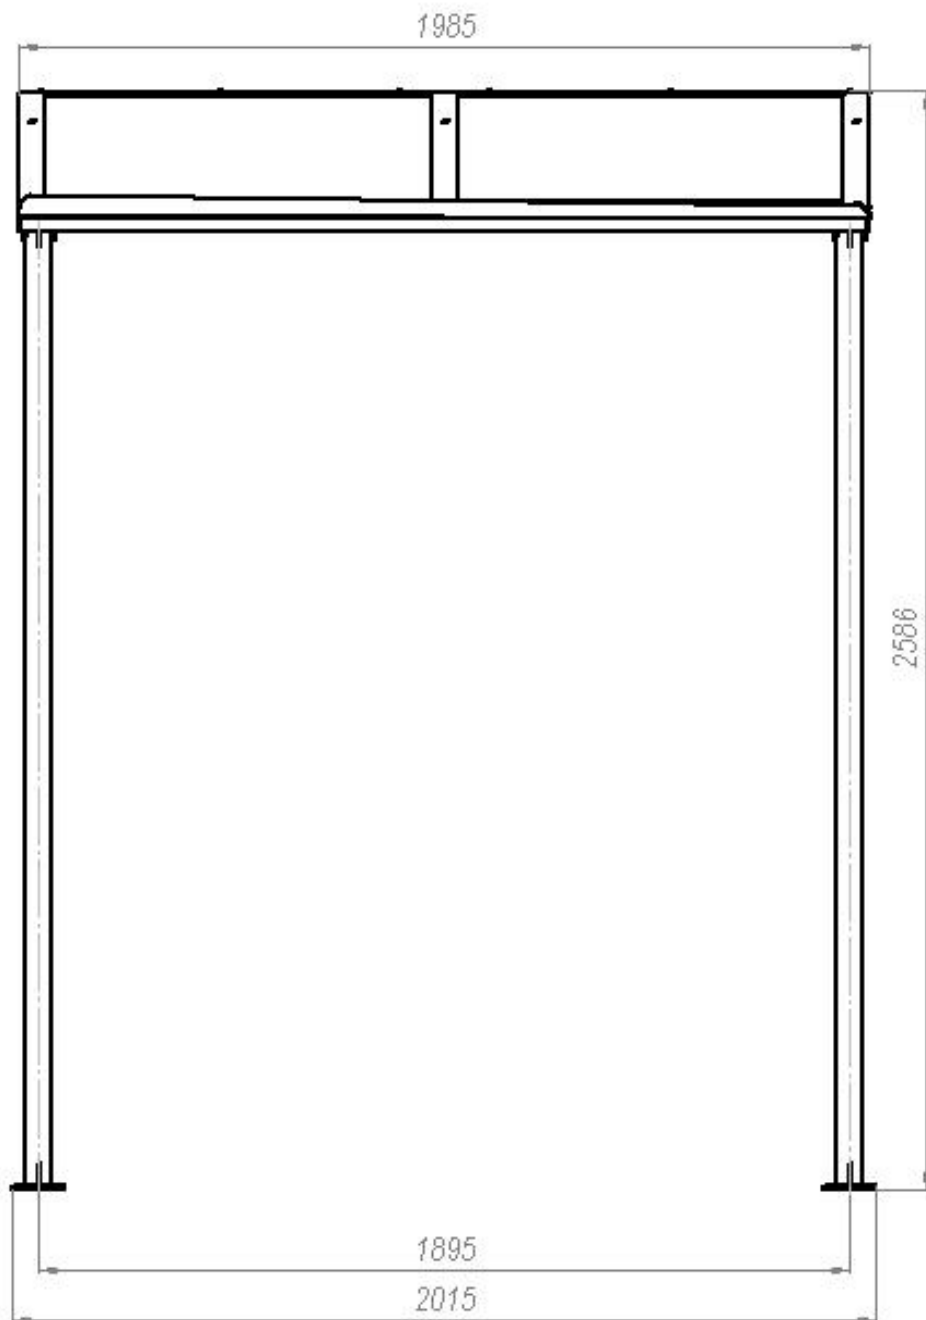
(б) – Габаритные размеры крыши (вид сбоку)
